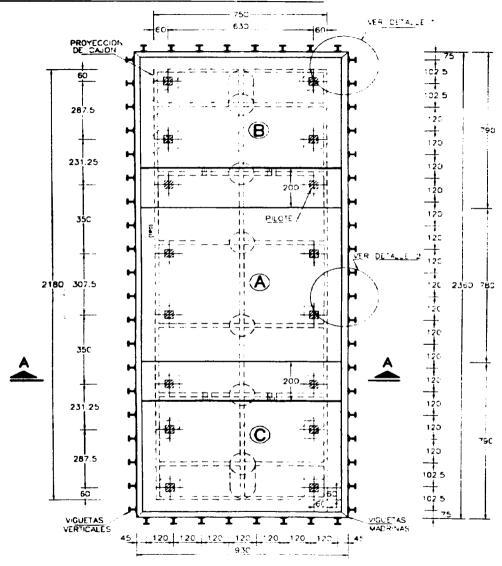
, 26 PLANTA DE EXCAVACION DEL CAJON TIPO 1
